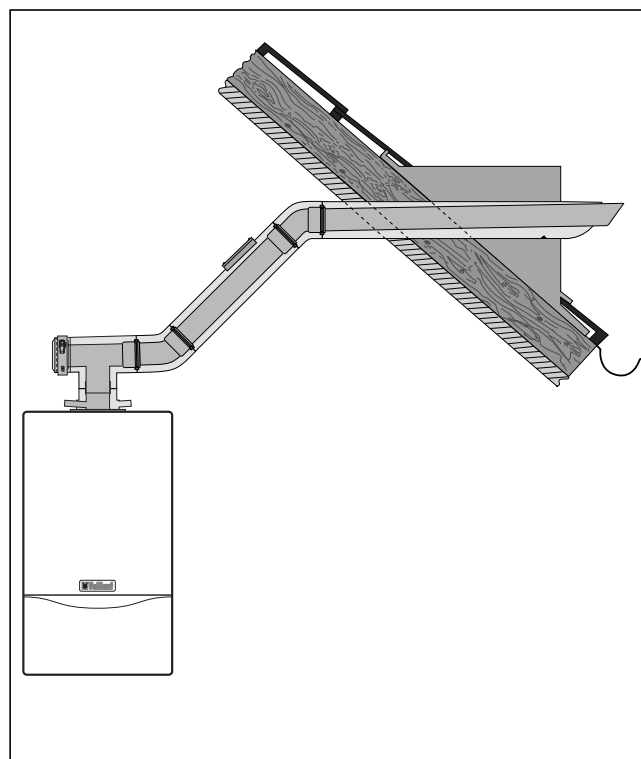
Esempio di montaggio: passante orizzontale per tetto
